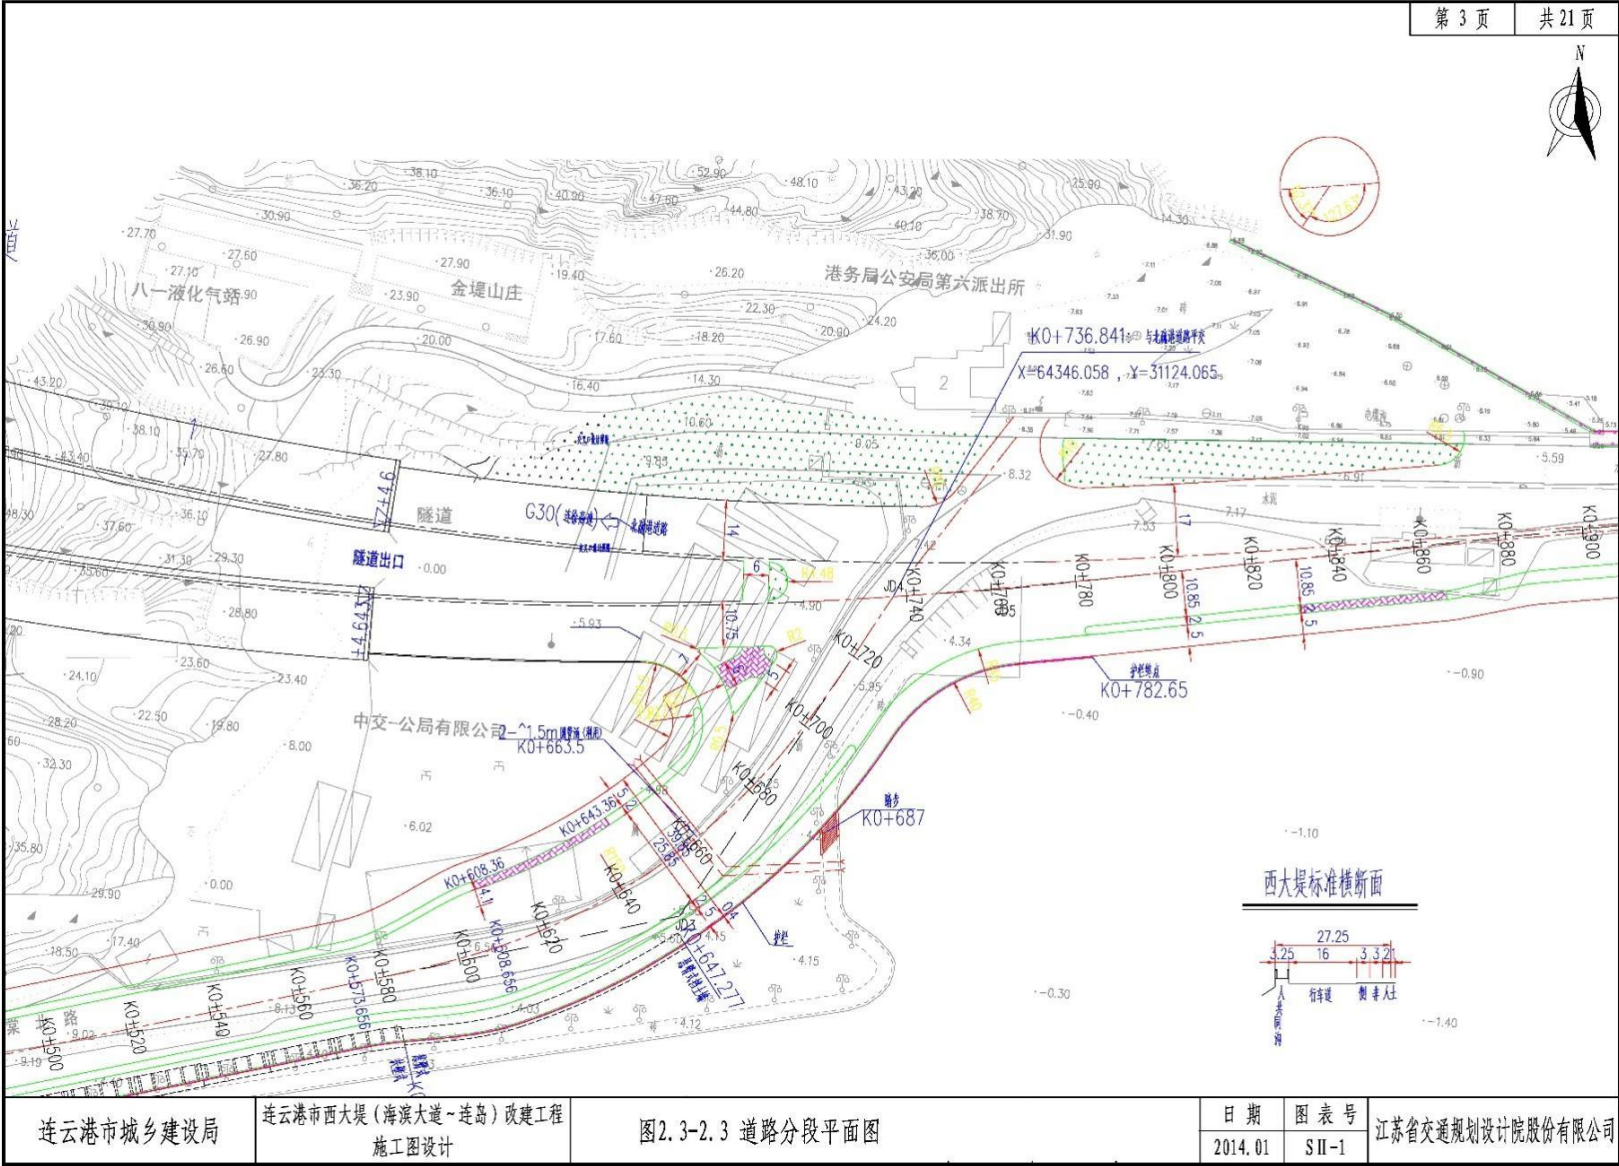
道路分段平面图（K0+680~ K0+900）
